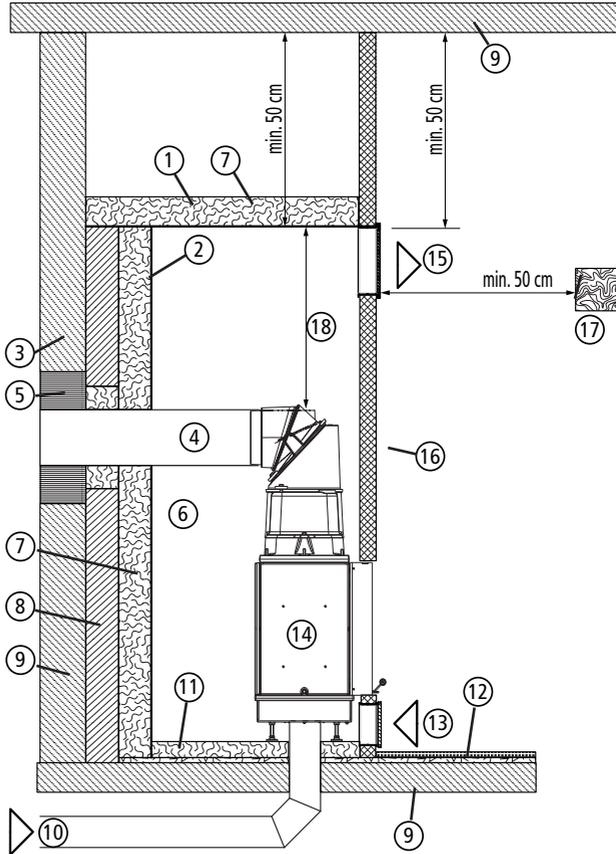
Schutz von brennbaren und nicht-brennbaren Anbauflächen (gem. DIN 18896)
